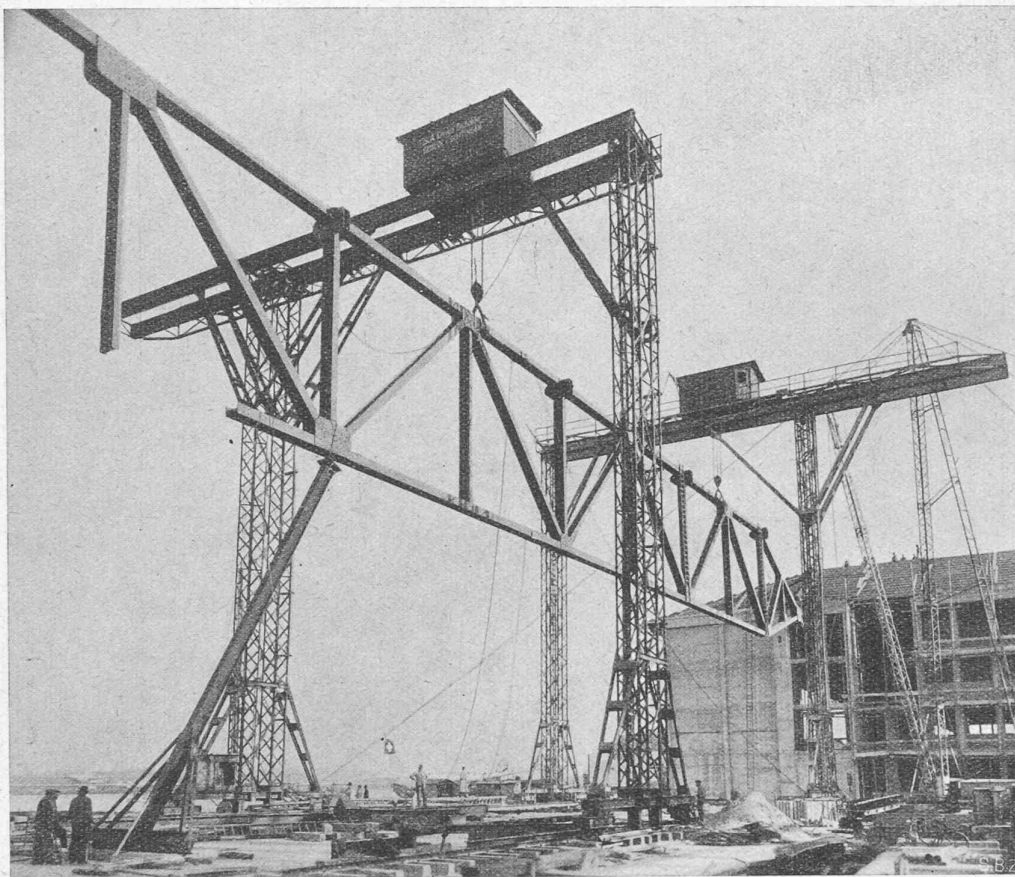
Halle de montage : Levage d'un élément de 70 t de la poutre maîtresse.
